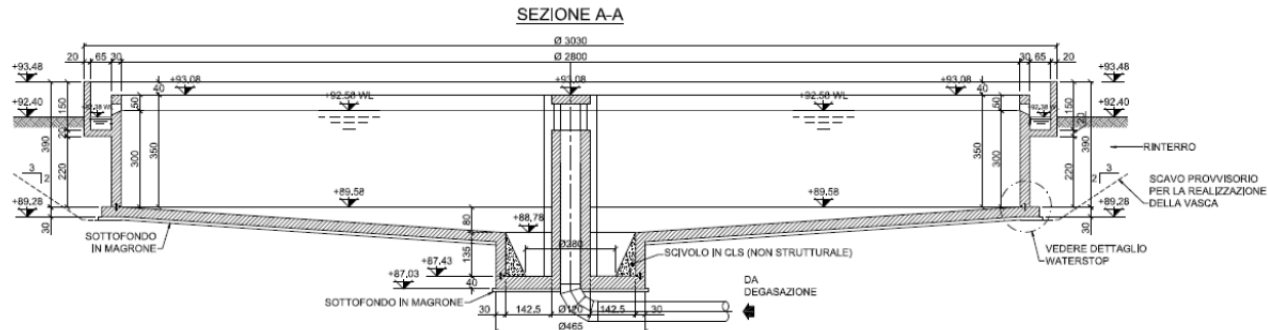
DECANTAZIONE FINALE - SEZIONE
